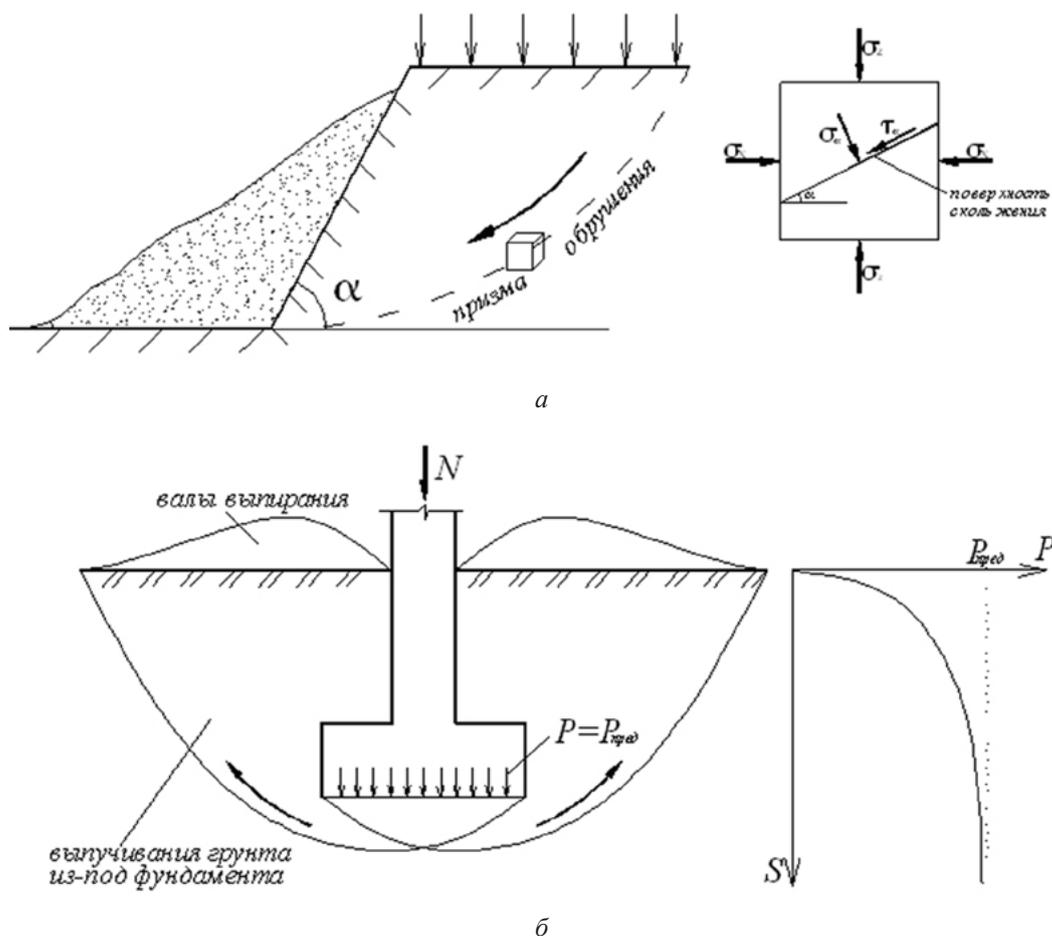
Схемы потери прочности грунта: а — обрушение откоса; б — выдавливание грунта из-под фундамента;  $P = P_{пред}$  — предельная вертикальная нагрузка на фундамент;  $P$  — нагрузка на фундамент;  $S$  — осадка фундамента
